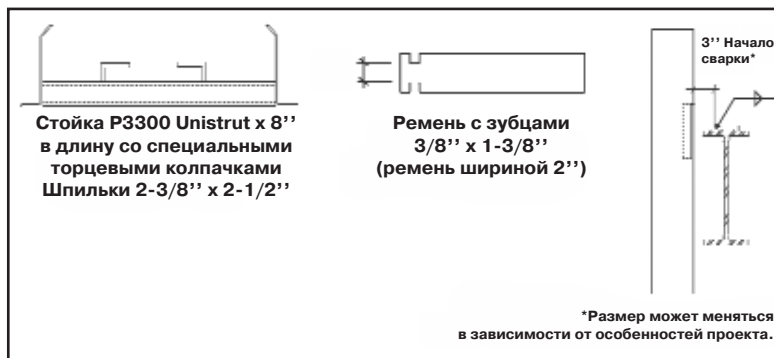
Конструкция верхнего соединительного узла, не воспринимающего нагрузку.
